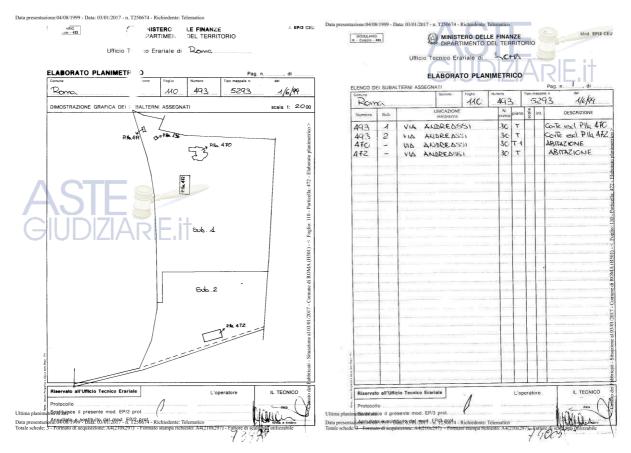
Elaborato planimetrico Fgl 110 p.lla 472 e 493 sub 2
